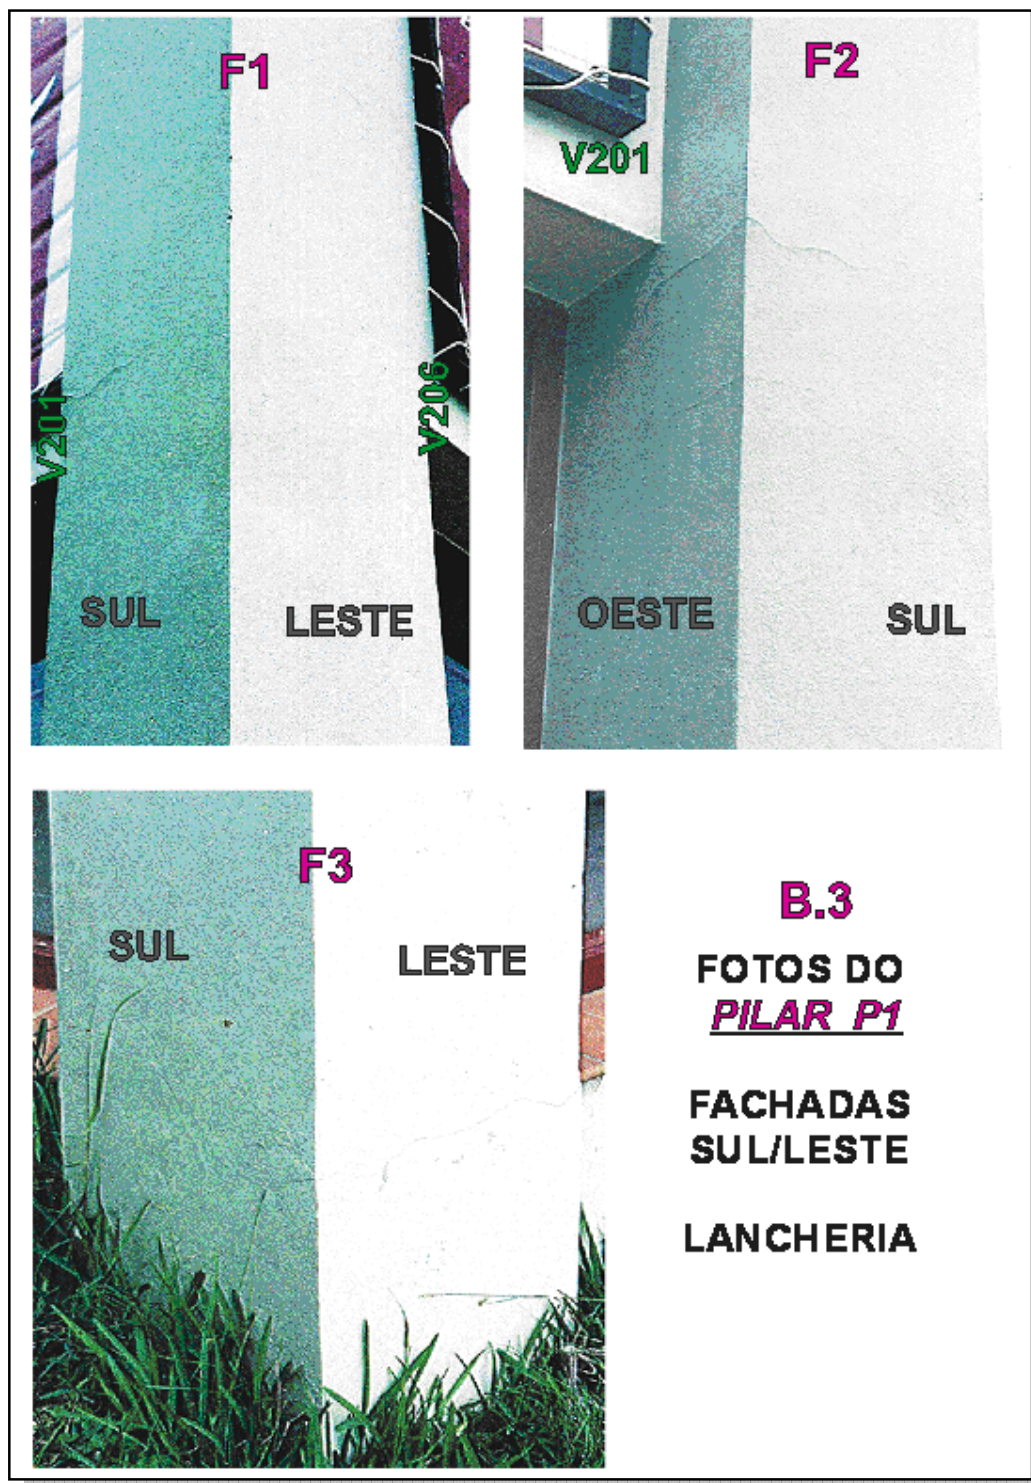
Fotos de fissuras manifestando-se no pilar P1, fachadas sul e leste da lancheria (ISAIA, 2001, p. 46)
